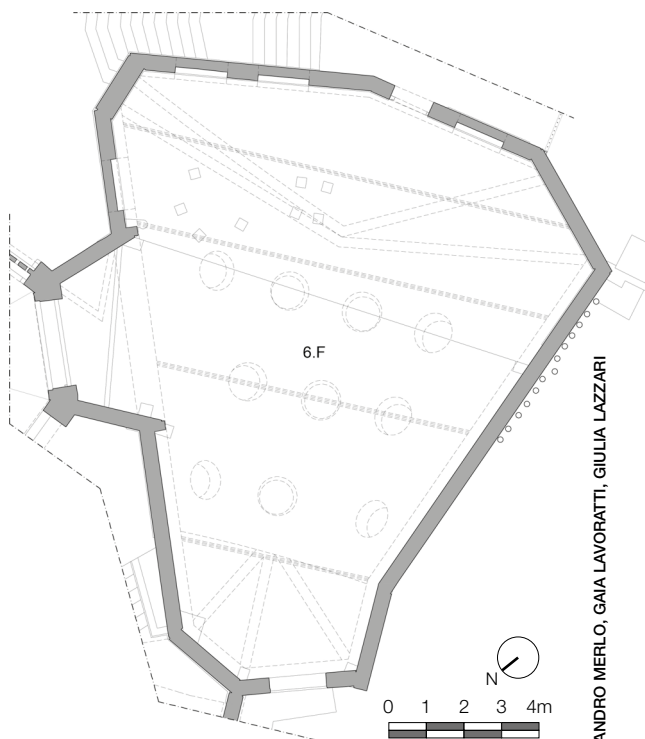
| Planta del bloque 6 (escala original de representación 1:50). | Pianta del blocco 6 (scala originaria di rappresentazione 1:50).
